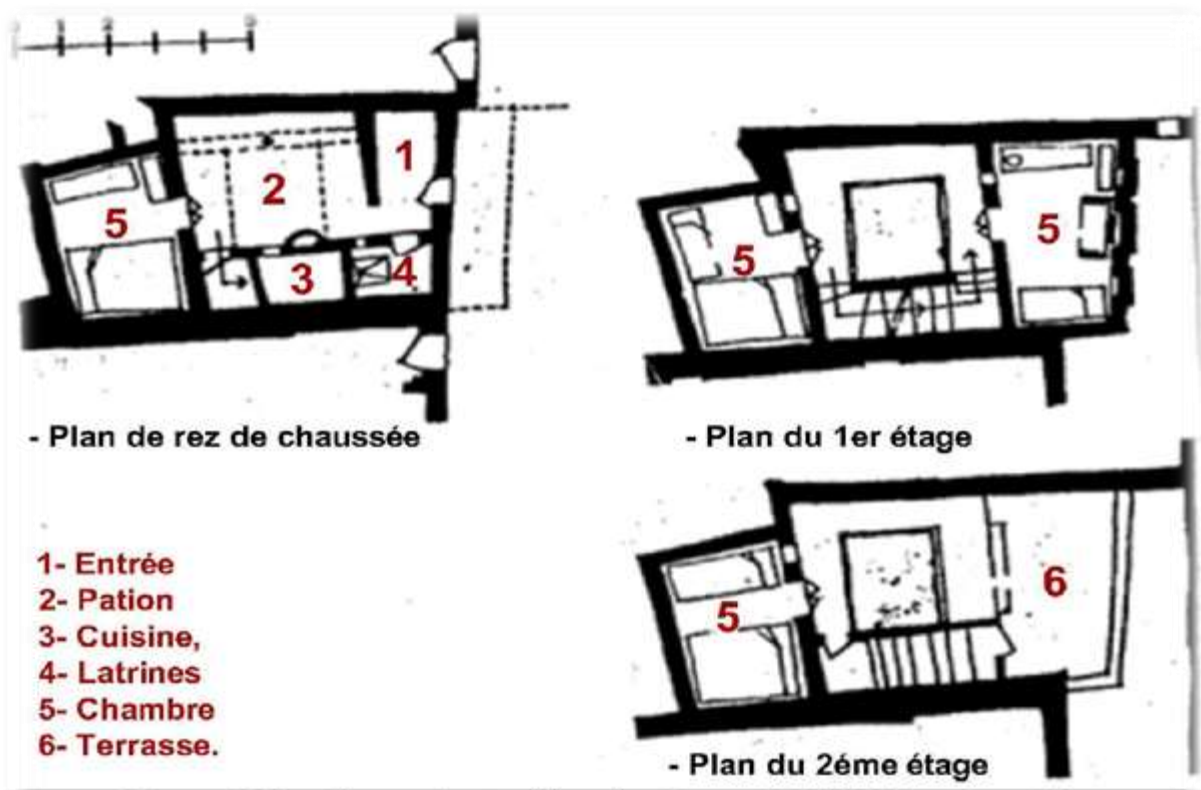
Plan d'une maison traditionnelle de la casbah d'ALGER-maison n°05.
